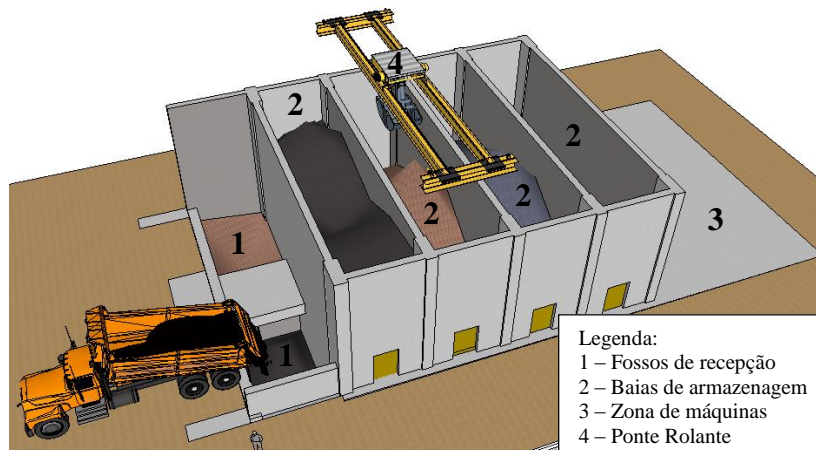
Perspectiva do Betão Armado mais a ponte rolante
